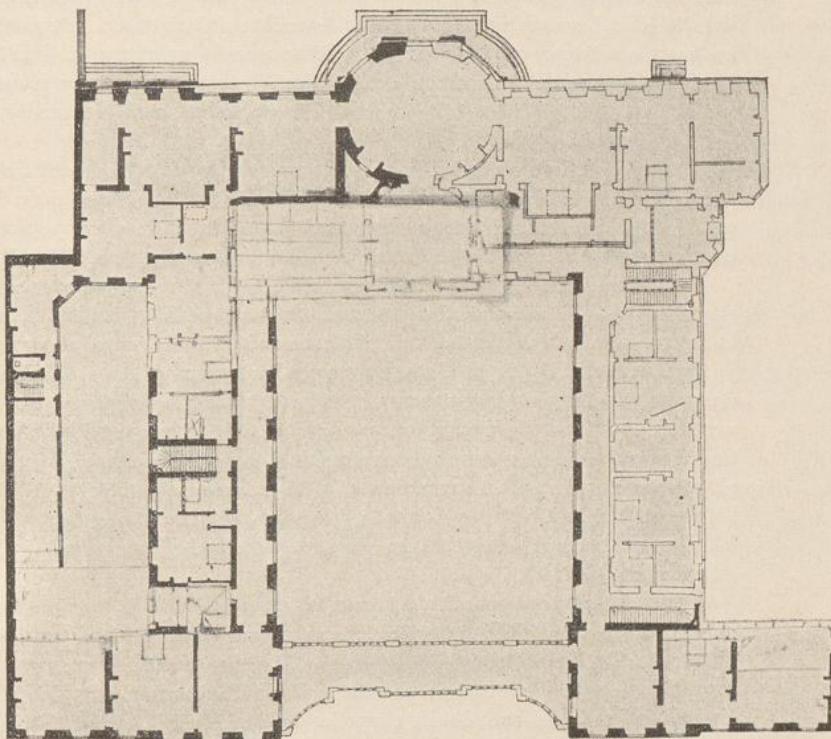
Palais Thurn und Taxis; Skizze de Cotes zum Grundriss des I. Obergeschosses.
